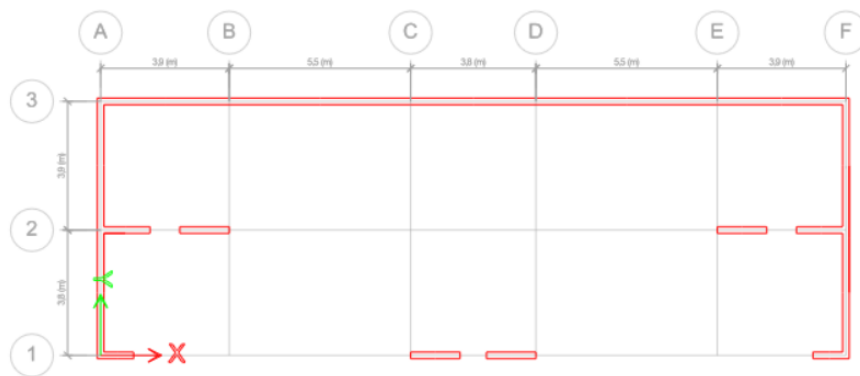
Disposition des voiles aux niveau sous-sol
